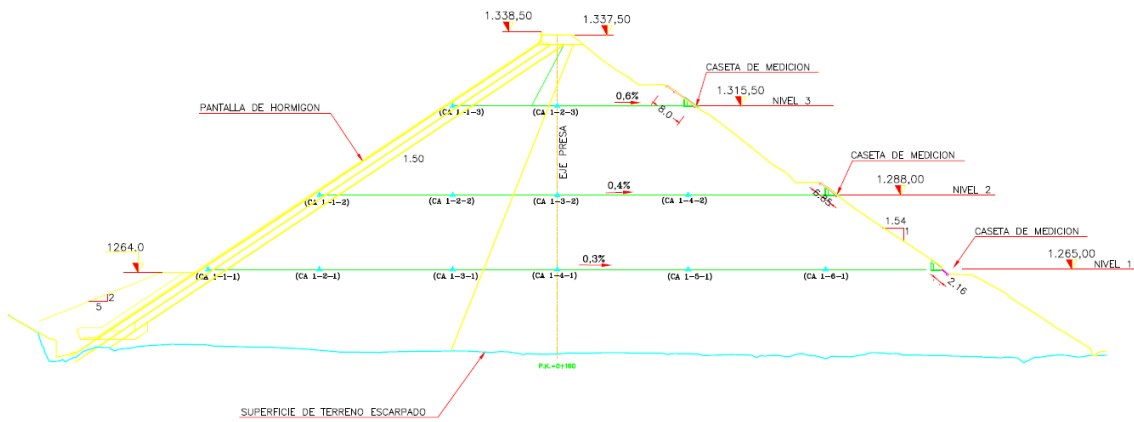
Plano del perfil transversal de la sección norte del embalse de Chacrillas (Documento nº 2 – Planos). Fuente: elaboración propia.
